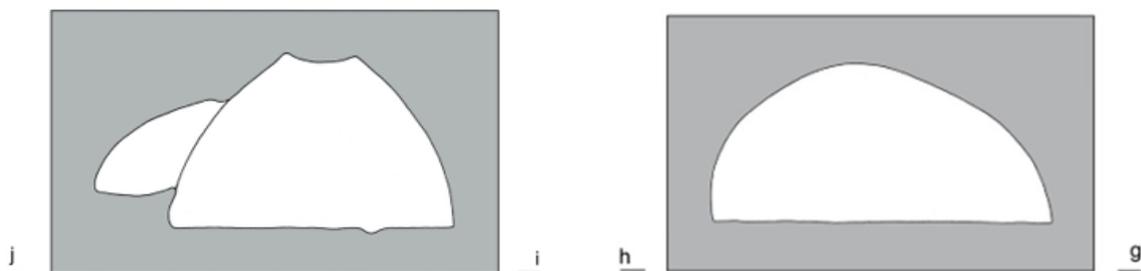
Sección transversal de la cubierta abovedada del sepulcro 11 (izquierda) y 9 (derecha)
